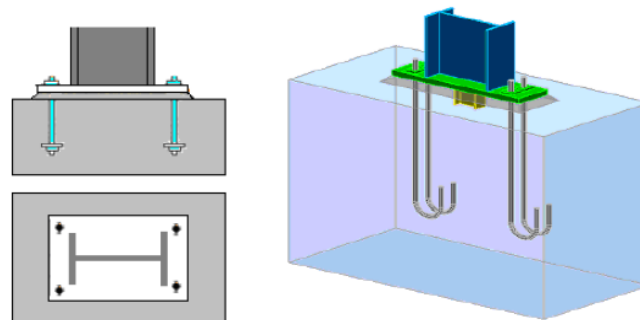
Pieds de poteaux encastré et emplacements pour les boulons d'ancrage.
